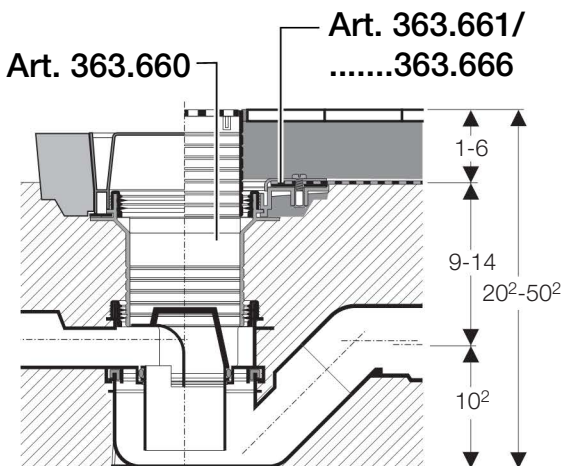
Einbau mit Verlängerungsaufsatz und Flansch (Dichtebene oben)
